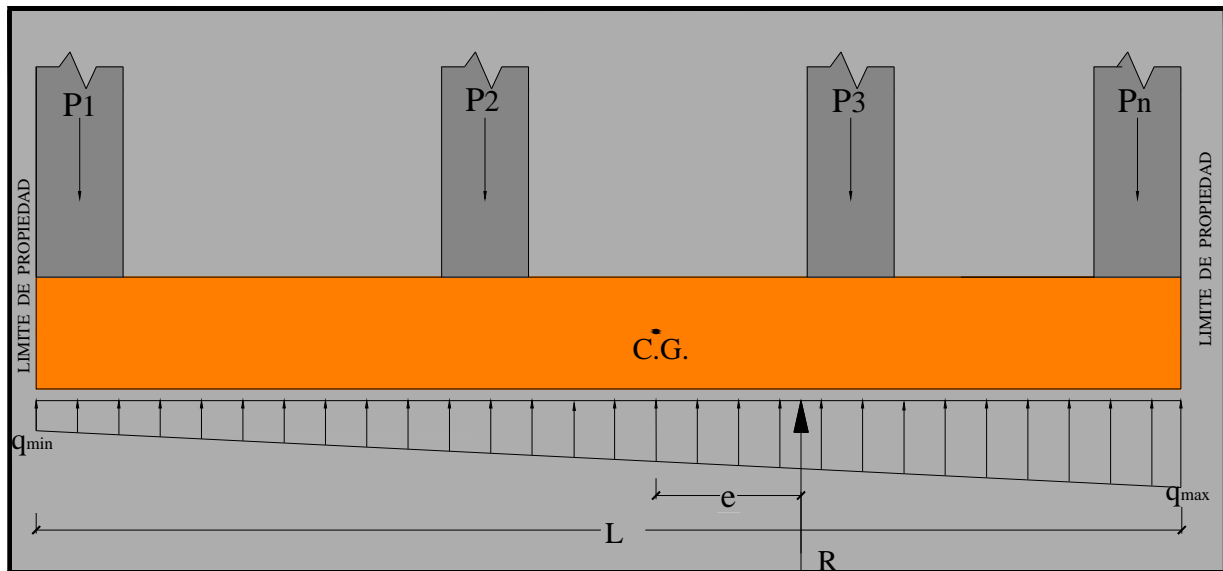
Vigas de fundación para $e \leq L/6$
